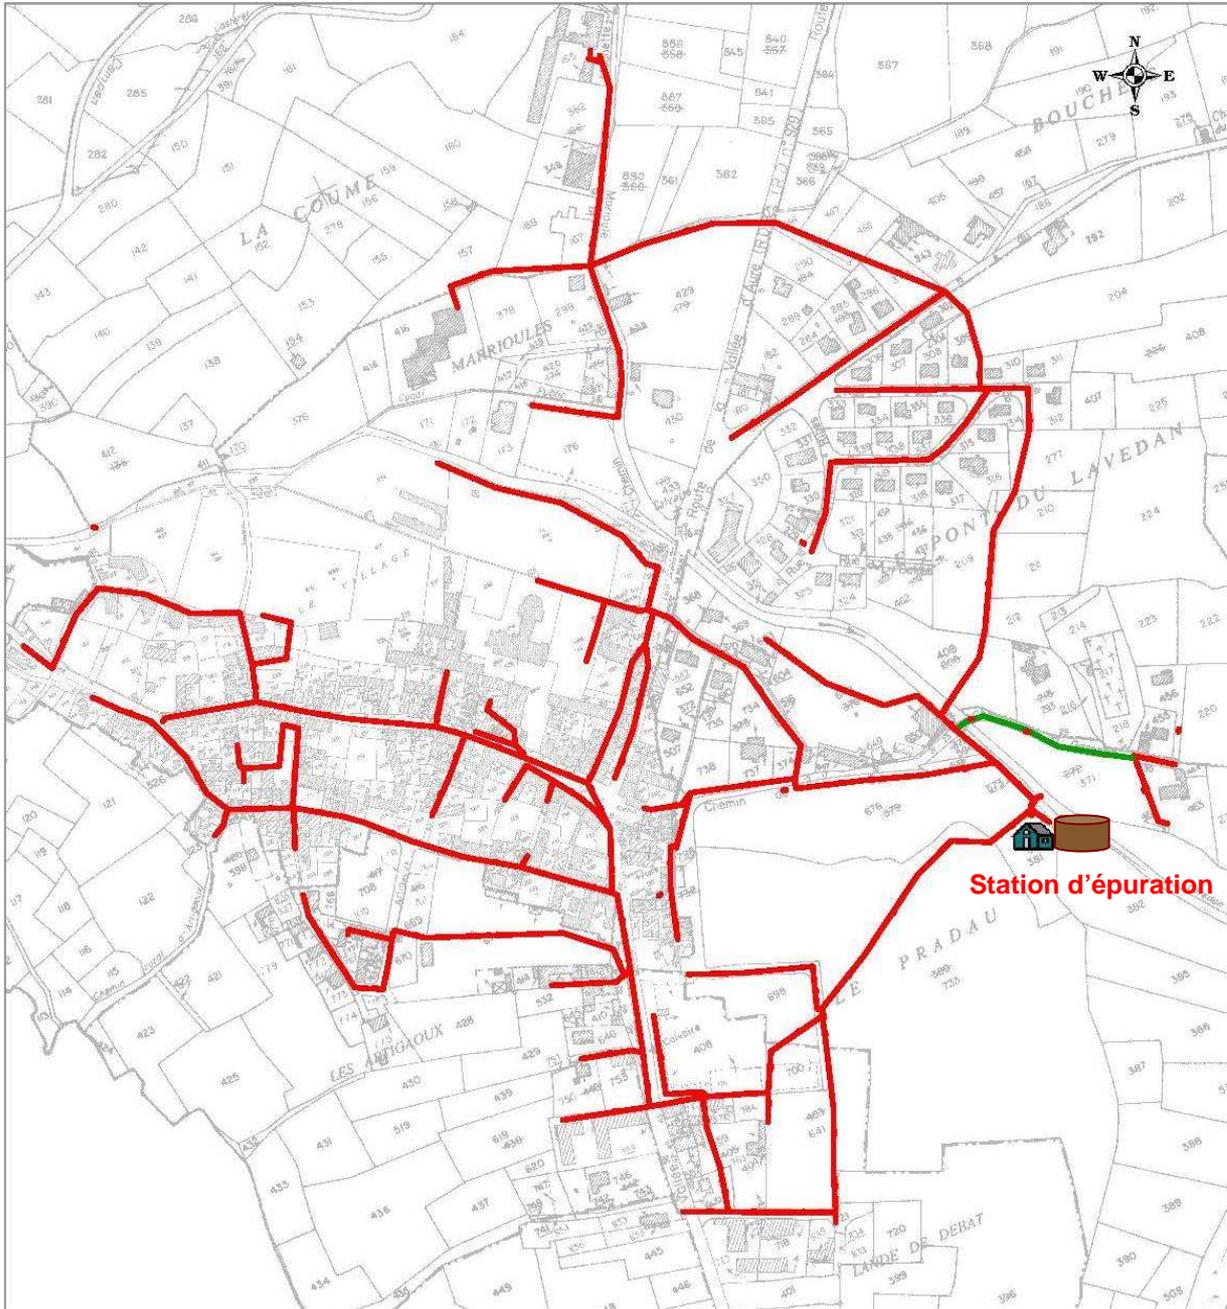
Plan du réseau d'assainissement de Guchen
